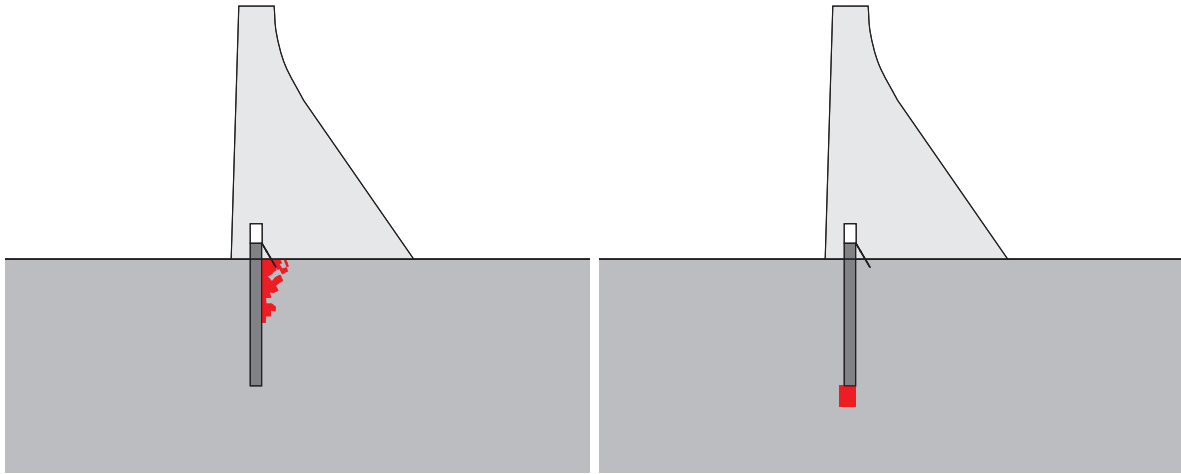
Erosionsgefährdete Untergrundbereiche der Gewichtsstaumauer mit Untergrunddrainage
